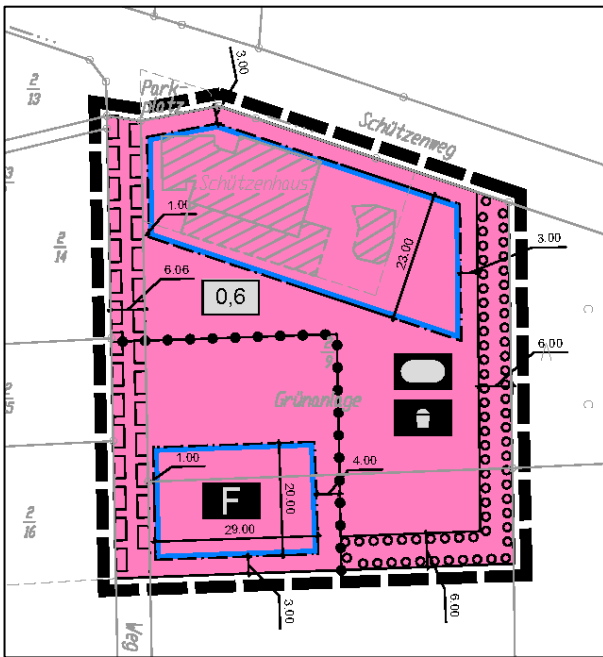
Zeichnerische Darstellung B-Plan Nr. 24 „Schützenweg“ (Ursprungsplan)
